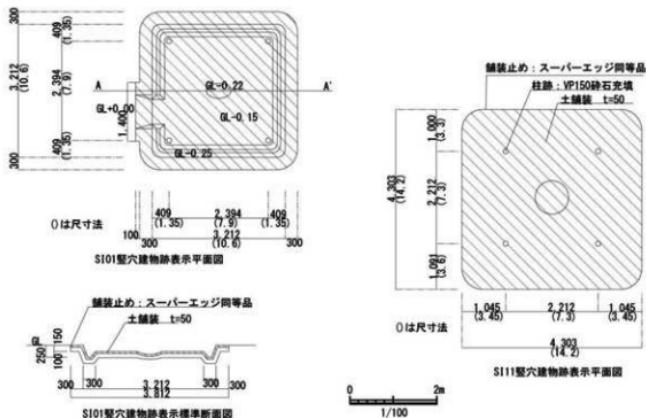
積穴建物跡 (SI01・SI11) 表示平面図
